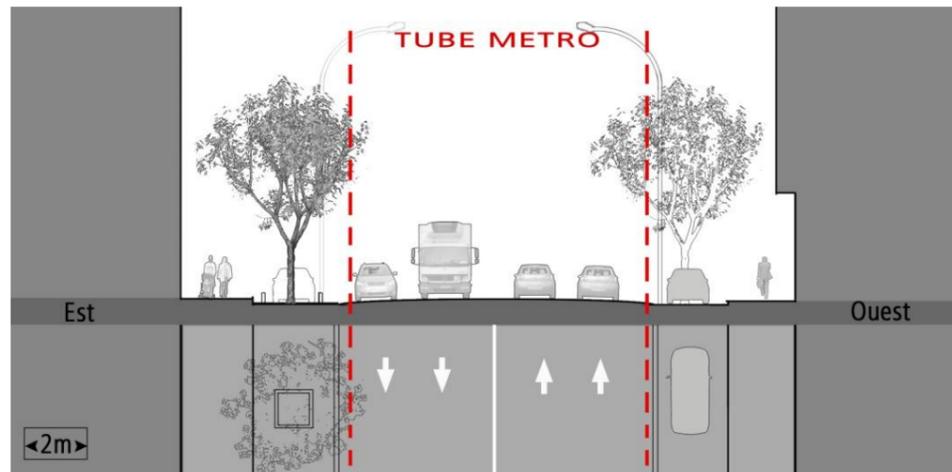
Existant - Coupe en section courante sur le profil contraint à 19,5 m
